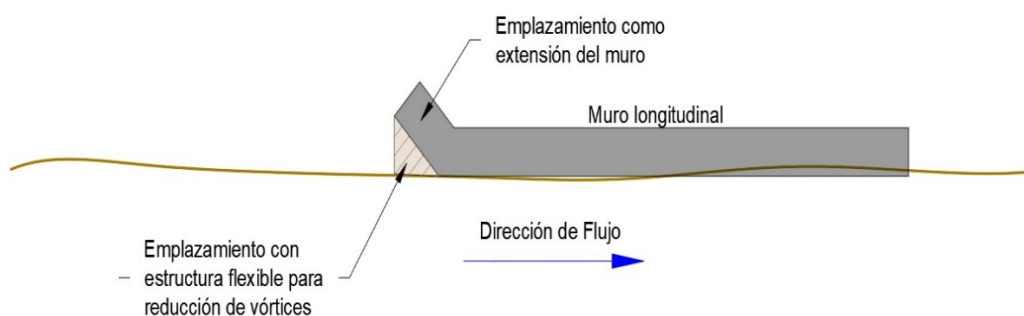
Vista en planta del emplazamiento horizontal del muro longitudinal
